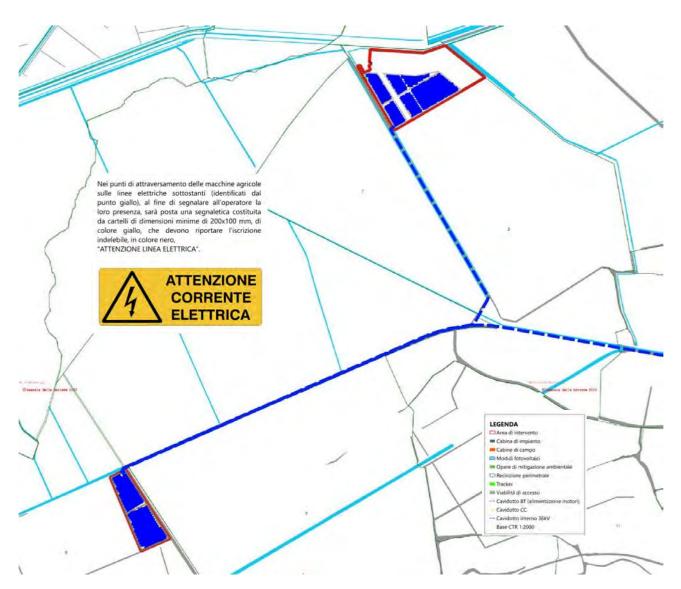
Planimetria dei tracciati e delle reti impiantistiche
